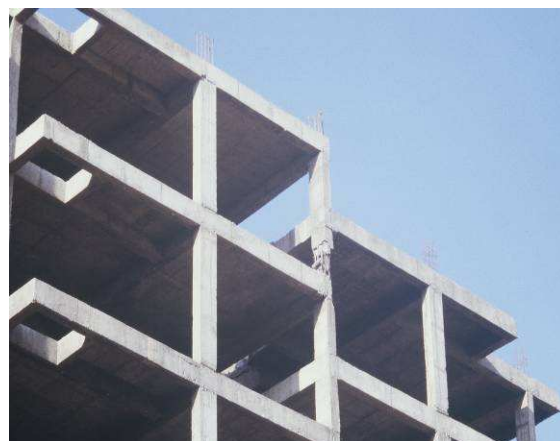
Bhuj 2001 - Poteaux courts dus à des niveaux de plancher décalés.
